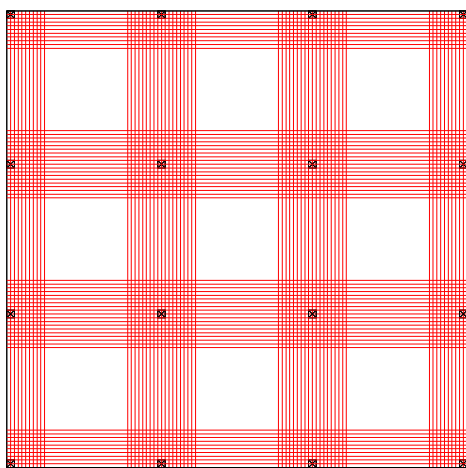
Alternativa de traçado 2 dos cabos no pavimento sem balanço
